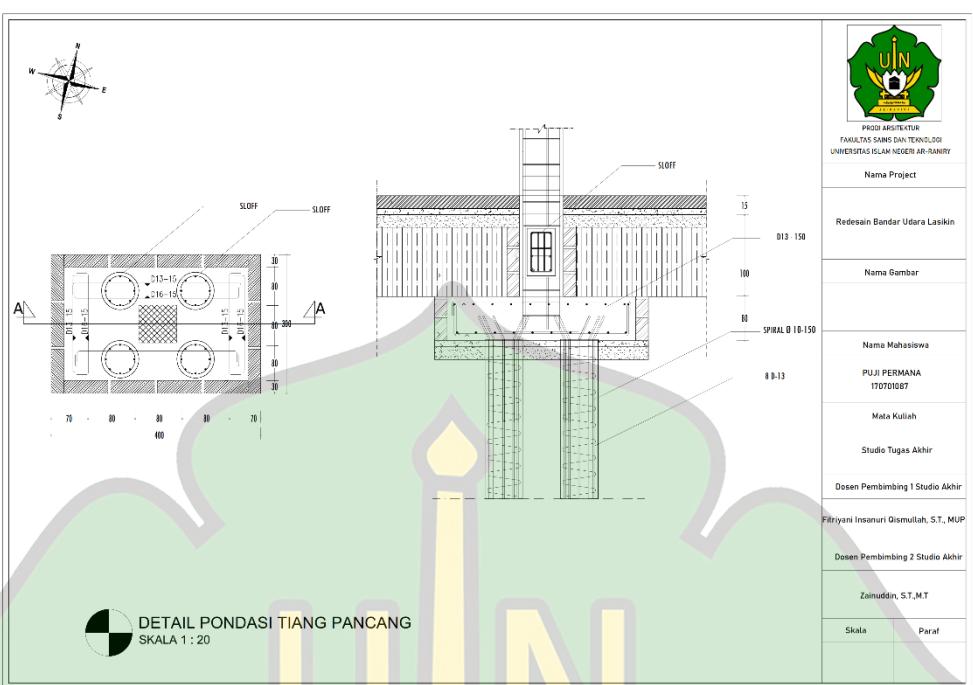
17 Rencana Pondasi Tiang Pancang
